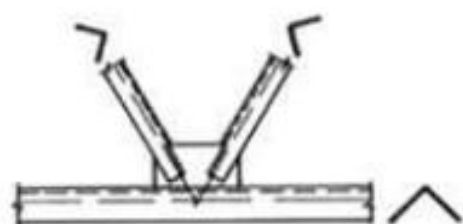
DETALHES DE TRELIÇAS SOLDADAS
